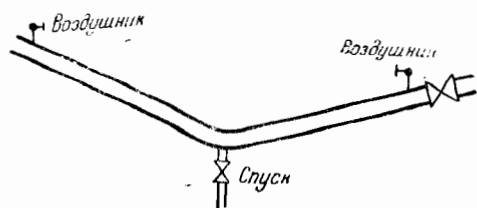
Схема расположения дренажных и воздушных кранов.
